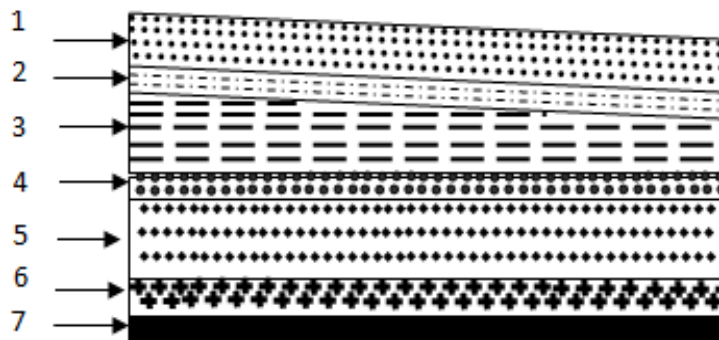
Plancher en corps creux de terrasse (inaccessible).
